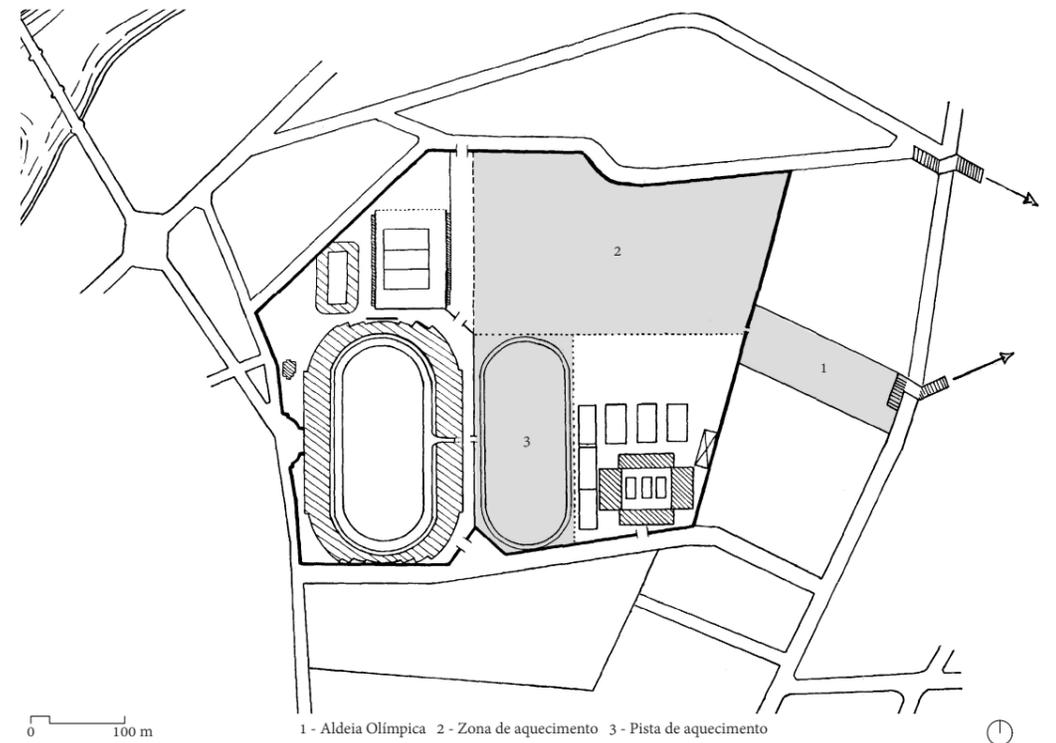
Planta de implantação da Aldeia Olímpica de Paris.
